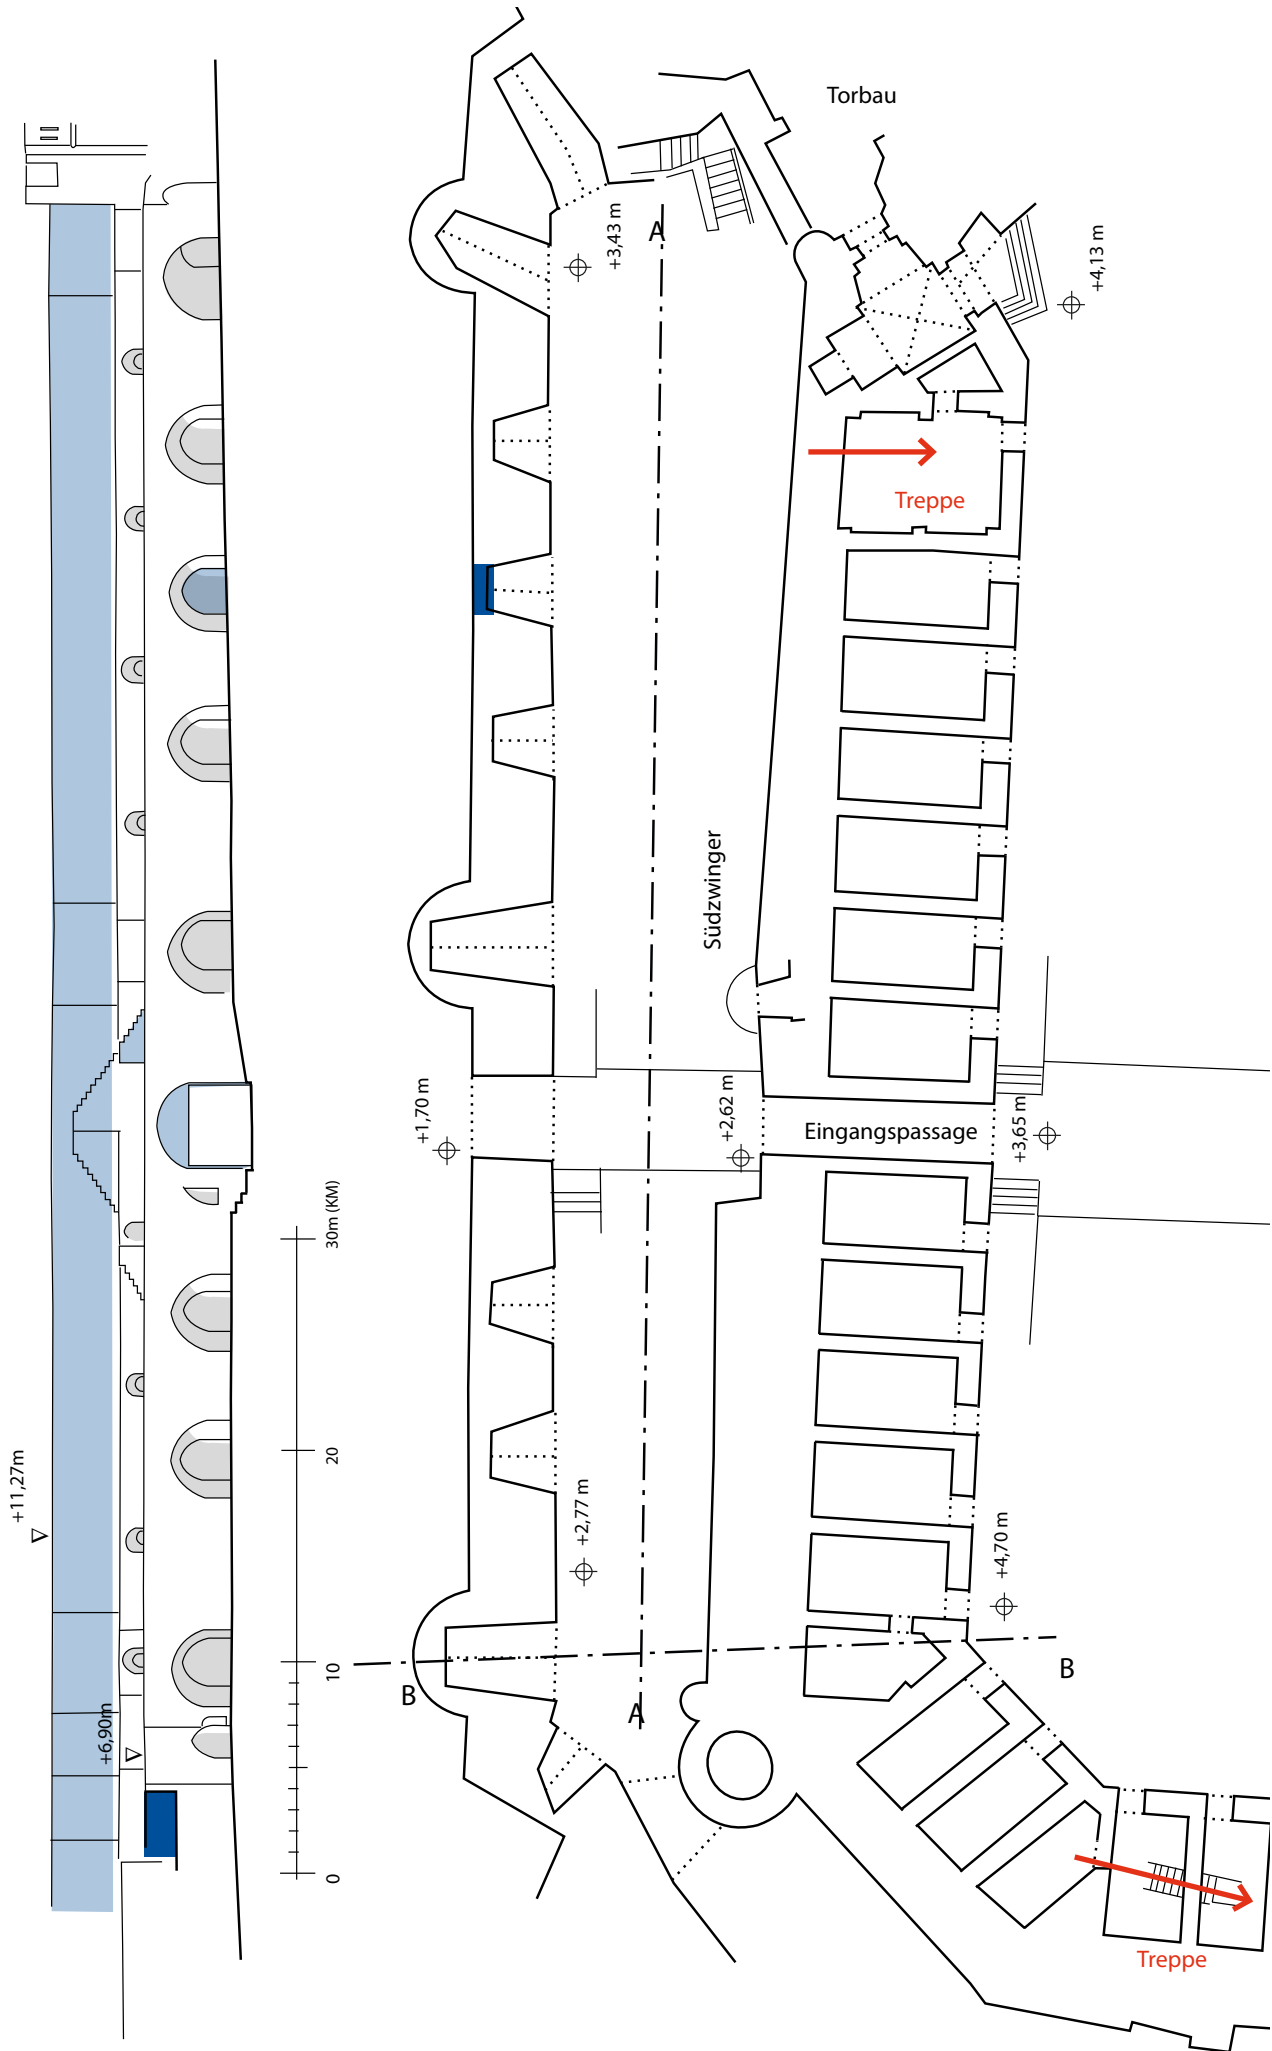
Die südliche Wehrmauer: Grundriss und Längsschnitt A-A.
